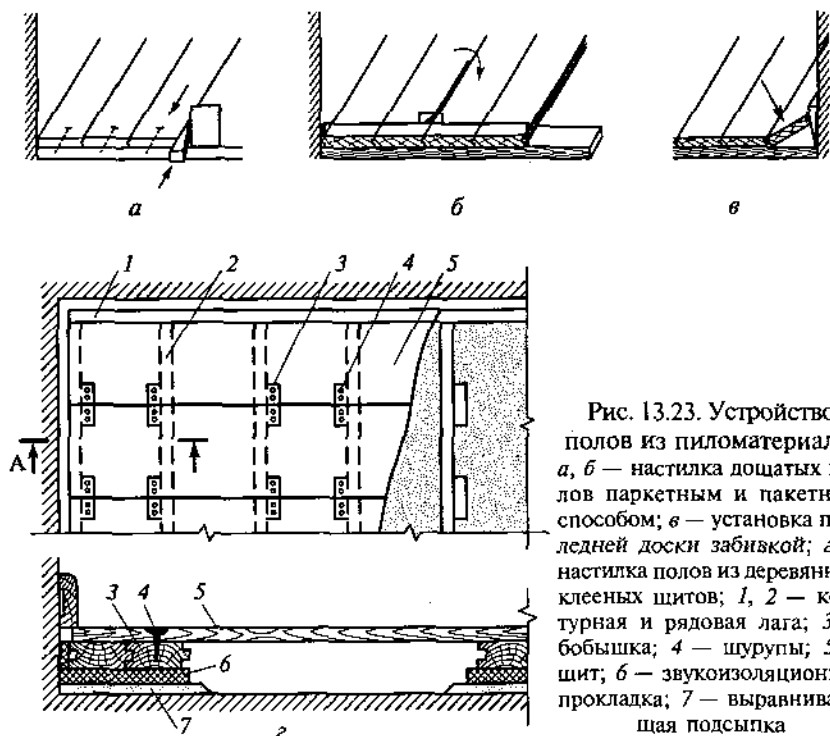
Устройство полов из пиломатериала: а, б — настилка дощатых полов паркетным и пакетным способом; в — установка последней доски забивкой; 2 — настилка полов из деревянных клееных щитов; 1, 2 — контурная и рядовая лага; 3 — бобышка; 4 — шурупы; 5 — щит; 6 — звукоизоляционная прокладка; 7 — выравнивающая подсыпка
